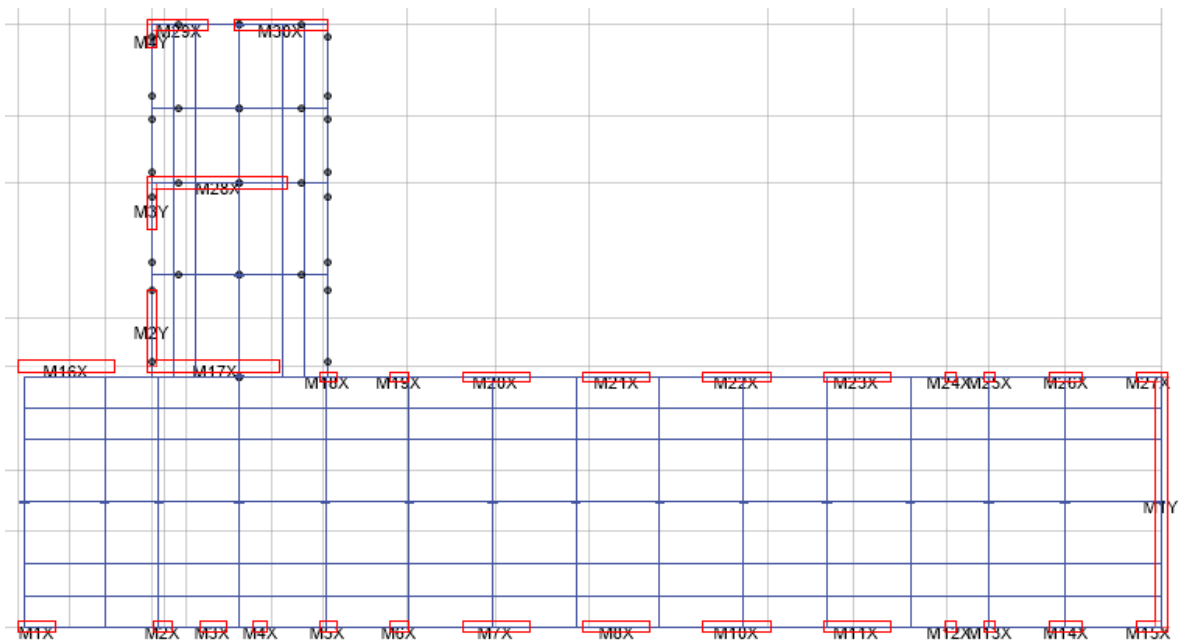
Se asignan los piers creados para los diversos tipos de muros en X y Y. Fuente: Autor.
